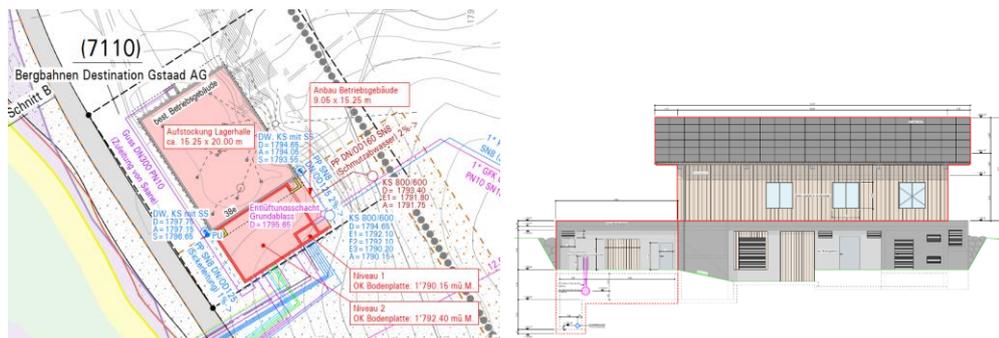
Aufstockung und Anbau des bestehenden Betriebsgebäudes, Ausschnitt Situationsplan und Fassadenansicht Nord-West Baueingabeplan (Quelle: Steiger Ingenieure + Planer AG)
